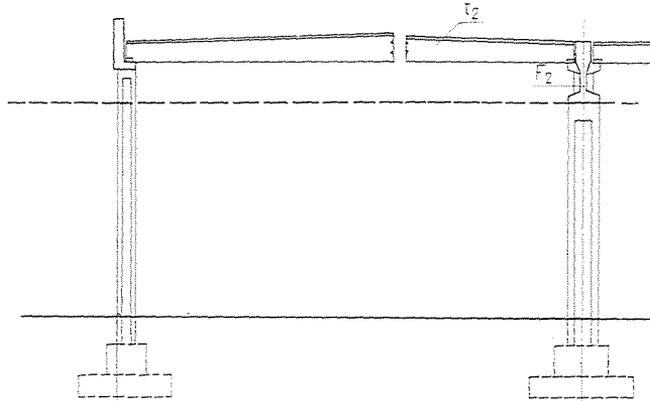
Comparaison des structures des halles industrielles, système à poutre maîtresse courte: F_2 = poutre maîtresse en béton armé précontraint d'une portée de 12 m; t_2 = panneau TT en béton armé précontraint d'une largeur de 2,5 m et d'une portée de 18 m
